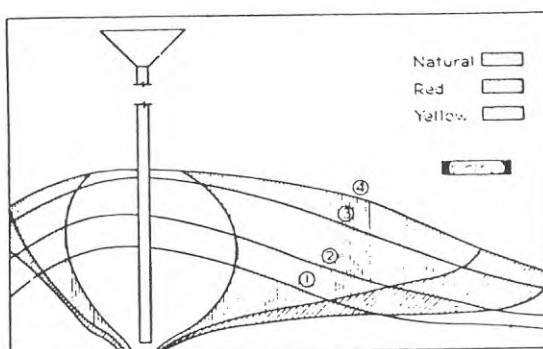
visar betongens utflytning. Först används betong med neutral färg tills dess betongytan når höjden enligt linje 1. Då används i stället betong med röd färg. Denna tvingar den neutralt färgade betongen uppåt. Efter en viss tid flyter den rödfärgade betongen upp på den gamla betongen och tvingar denna ut mot kanterna. När betongytan nått höjden enligt linje 2 används i stället gult färgad betong till höjden enligt linje 3. Då används åter neutralfärgad betong som når den slutgiltiga höjden enligt linje 4. Vid gjutningens början strömmar betongen horisontellt ut mot kanterna men när motståndet från redan gjuten betong ökar, ändras tryckförhållandena inuti betongmassan och trycklinjerna får ett utseende av en boll. Bollen expanderar och pressar i alla riktningar. Överliggande betong tvingas utåt och uppåt och underliggande betong utåt och nedåt.
